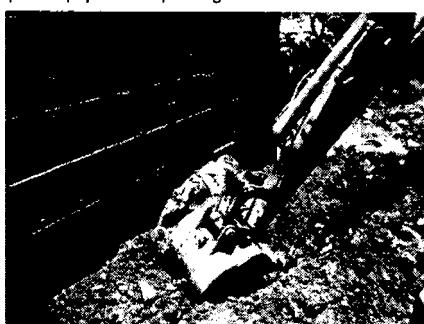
Escavação com escavadeira para a retirada de pilar de concreto pertencente a construção anterior.
